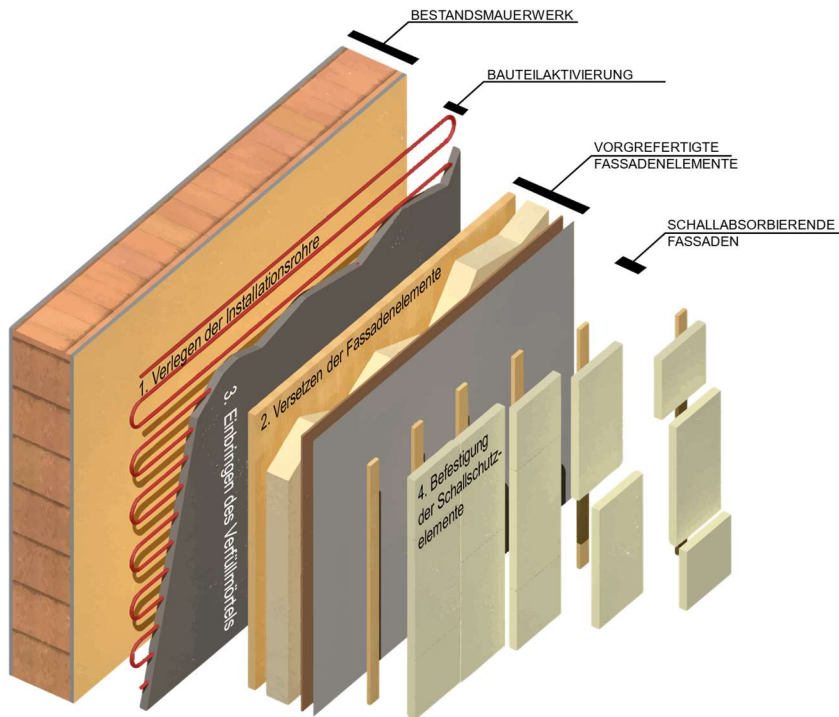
Projekt „Wohnen findet statt“ Multifunktionsfassade: Aufbau der Fassade mit außenliegender Bauteilaktivierung © FH Salzburg
